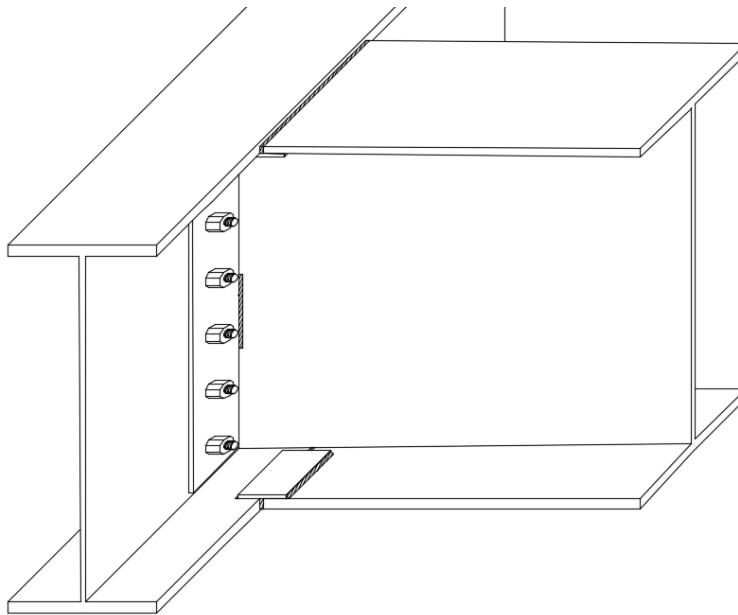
Vista en perspectiva de la unión entre vigas transversales y longitudinales.
